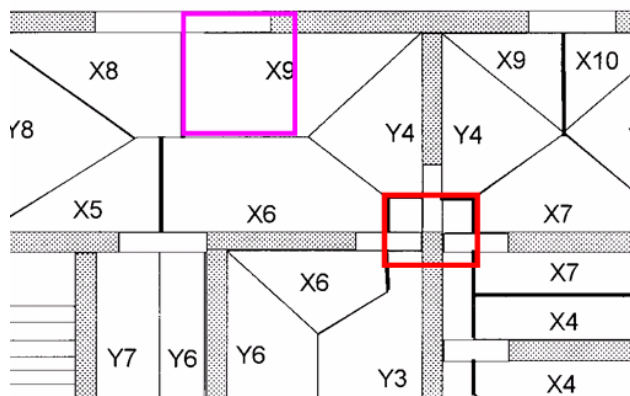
Área tributaria en un borde libre de un muro armado. Vista en planta.
